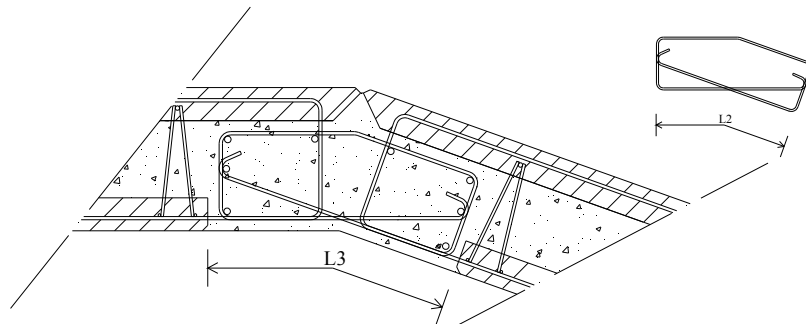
Etanchéité d'un mur d'épaisseur 30 cm
